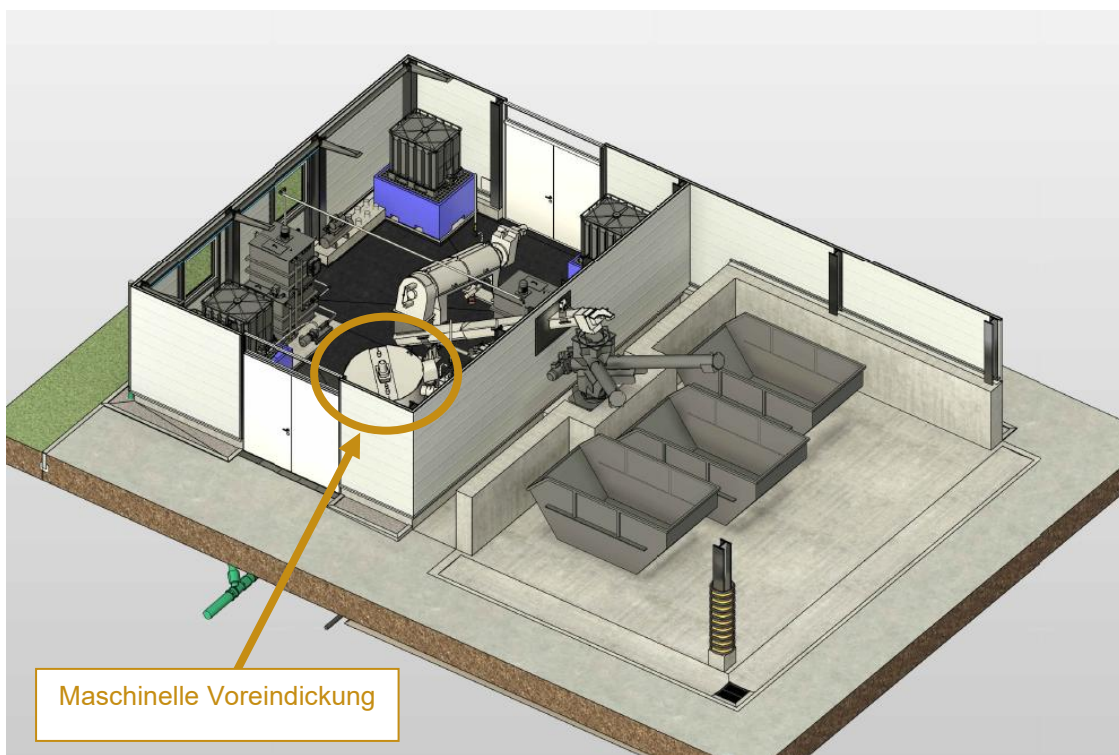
Grundriss maschinelle Schlammmentwässerung mit Voreindickung
